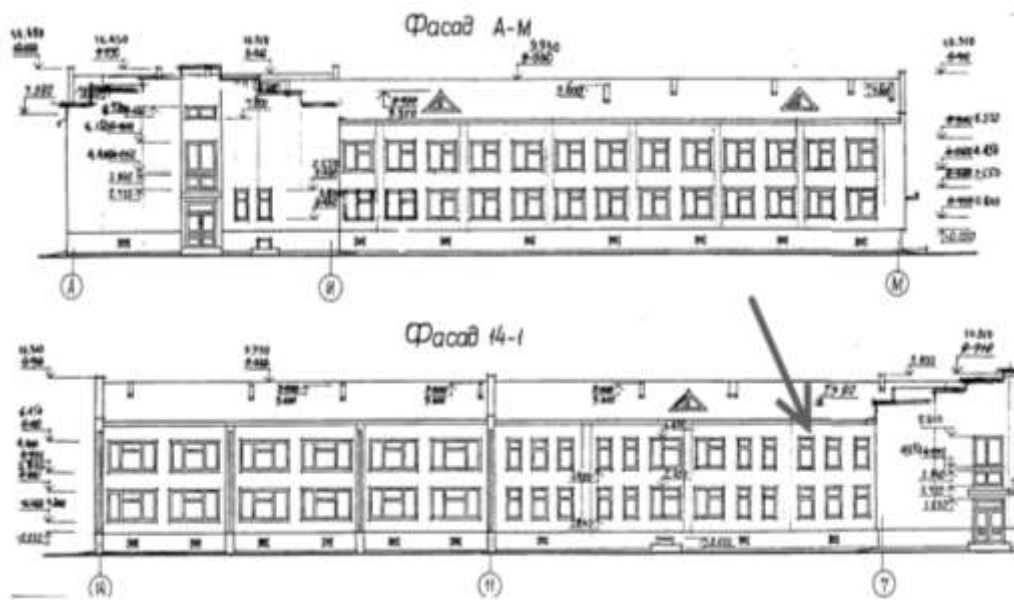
Проектні рішення фасадів шкільної будівлі з вікнами, які не забезпечують дотримання вимог природного освітлення
